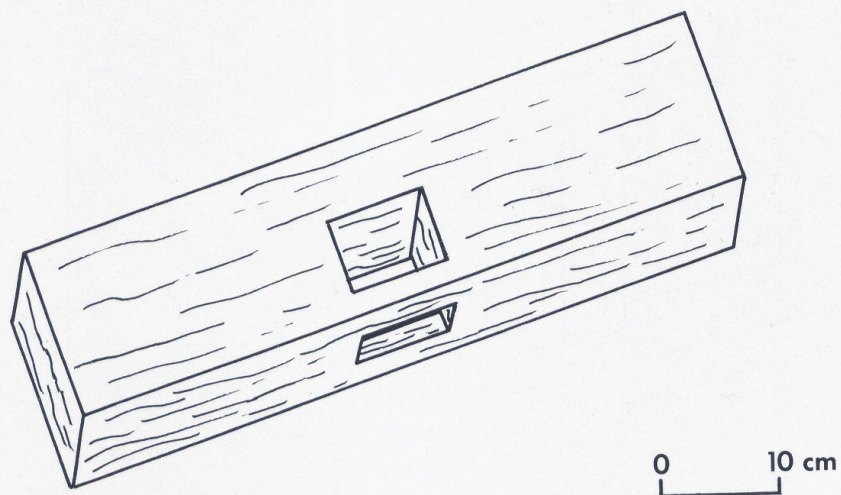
Élément de construction en bois provenant du remplissage du puits
